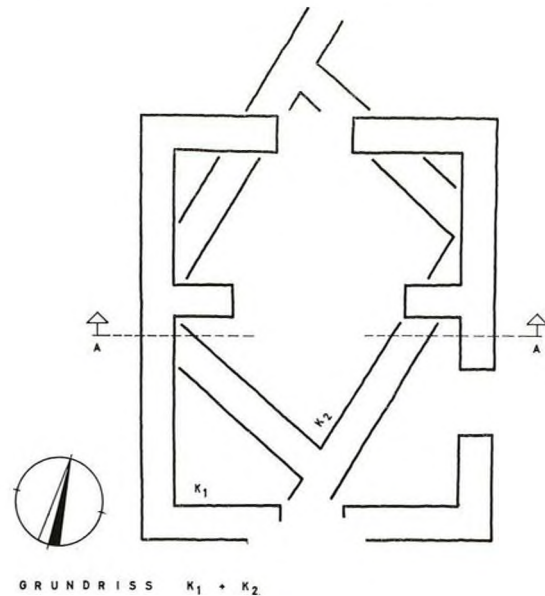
Grundriß und Schnitt vom Bau „K<sup>1</sup>“ (K. SCHMIDT)
